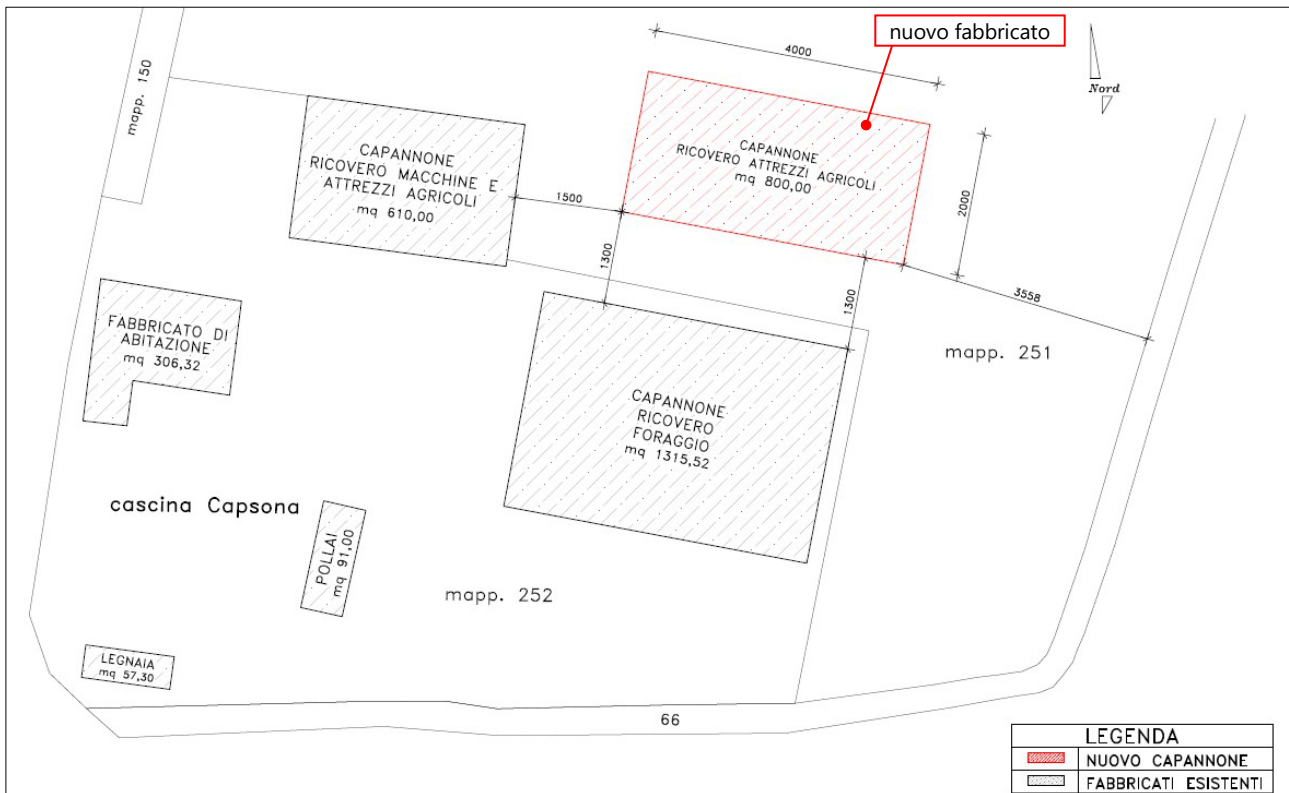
Planimetria del nuovo fabbricato e localizzazione specifica nel complesso di C.na Capsona.
